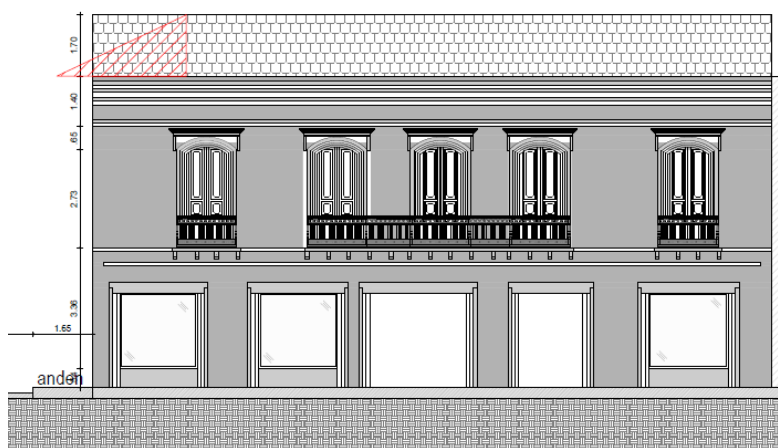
Fachada Actual calle 18. Fuente: Propia
